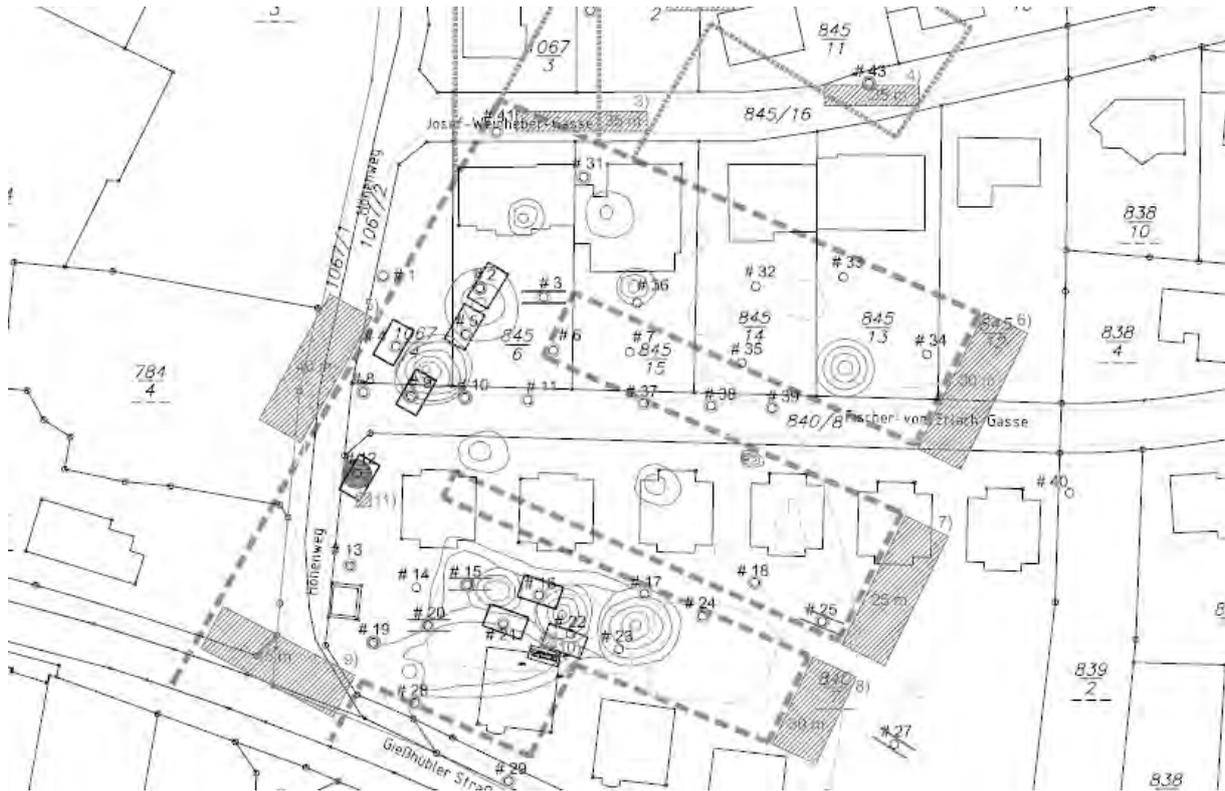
Ausschnitt aus einem Lageplan für Erkundungsbohrungen mit der vermuteten Lage der Hohlräume. Projekt Sanierung Marienhöhe.
